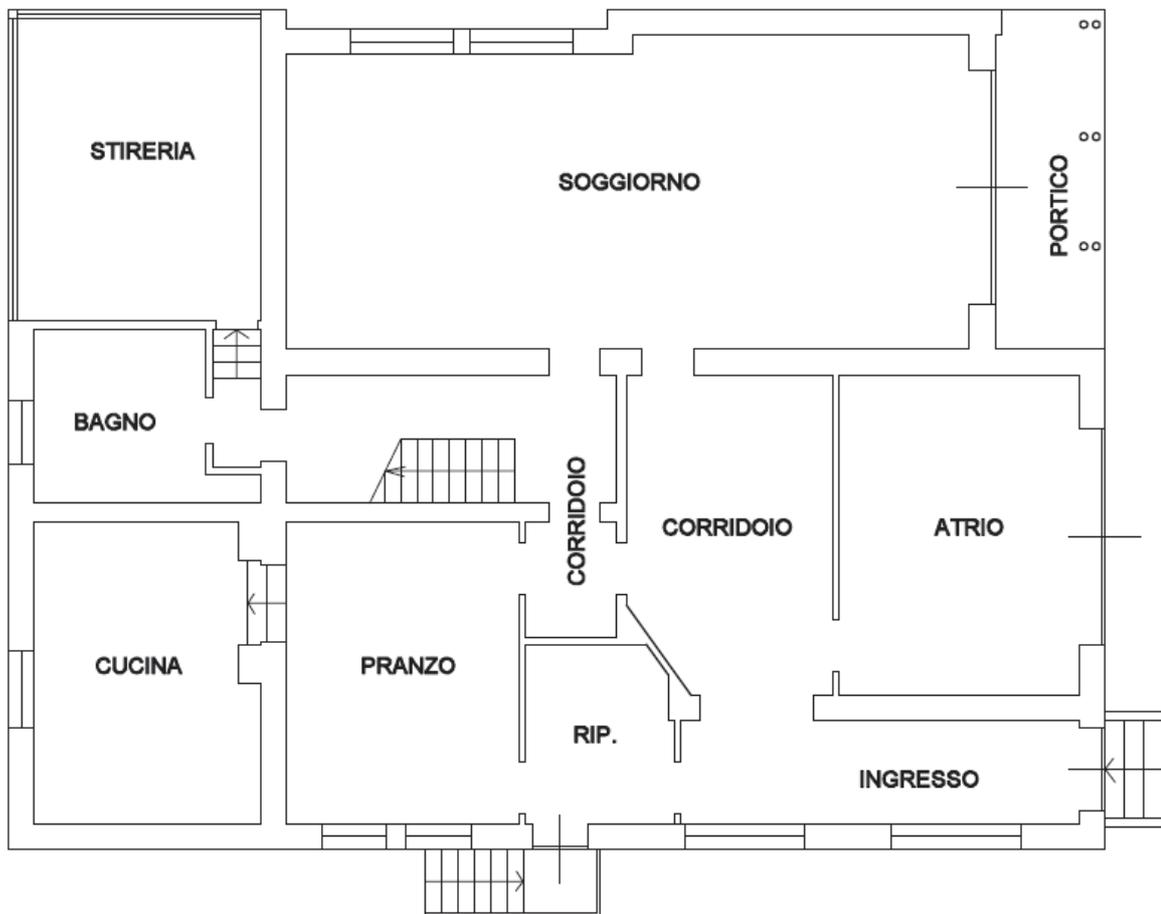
schema a vista (fuori scala) del fabbricato oggetto di esecuzione
